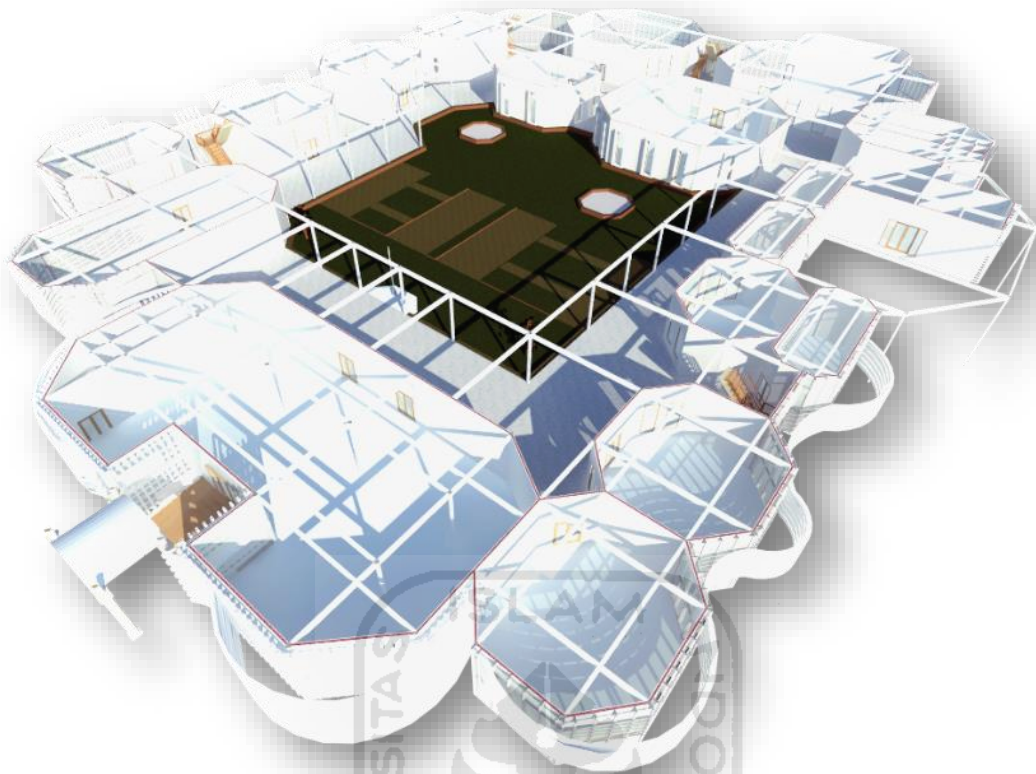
Rencana Kolom Balok (sumber : penulis 2015)
